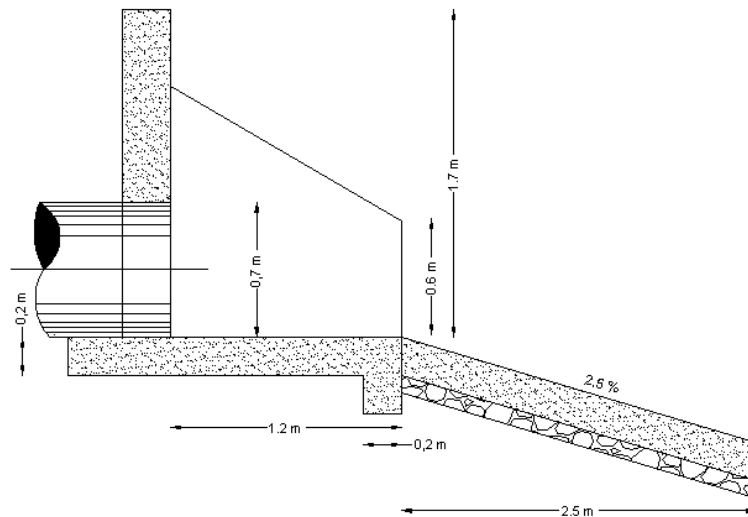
Sección Tipo de la alcantarilla Tipo 1
